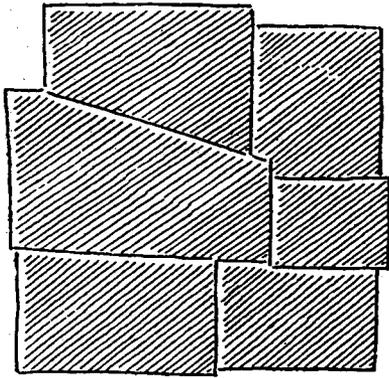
GENRE D'ASSEMBLAGE FRÉQUENT
